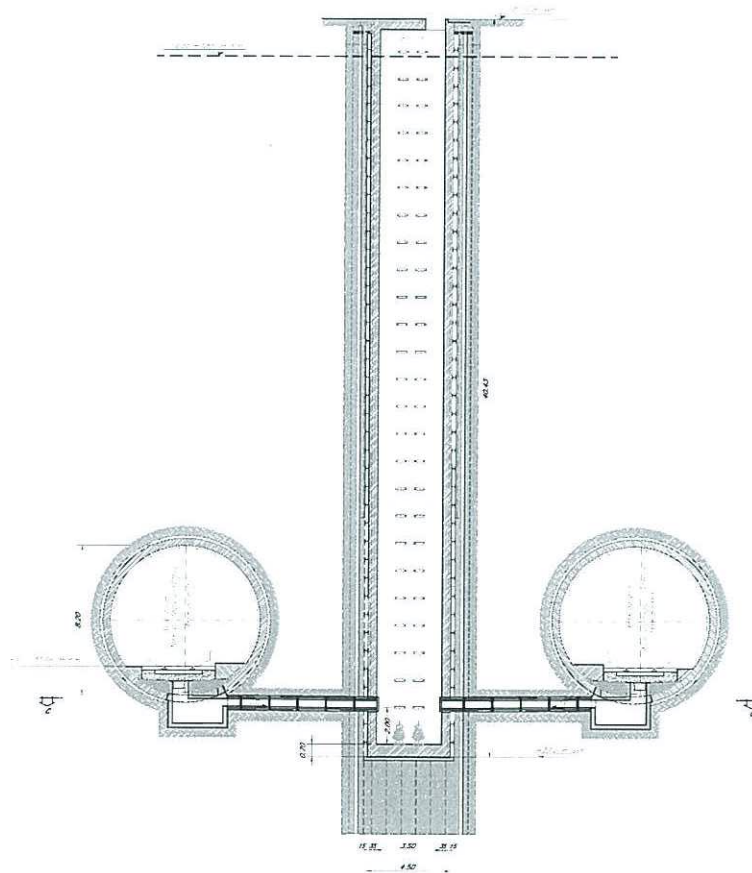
Sezione longitudinale del pozzo di aggettamento
